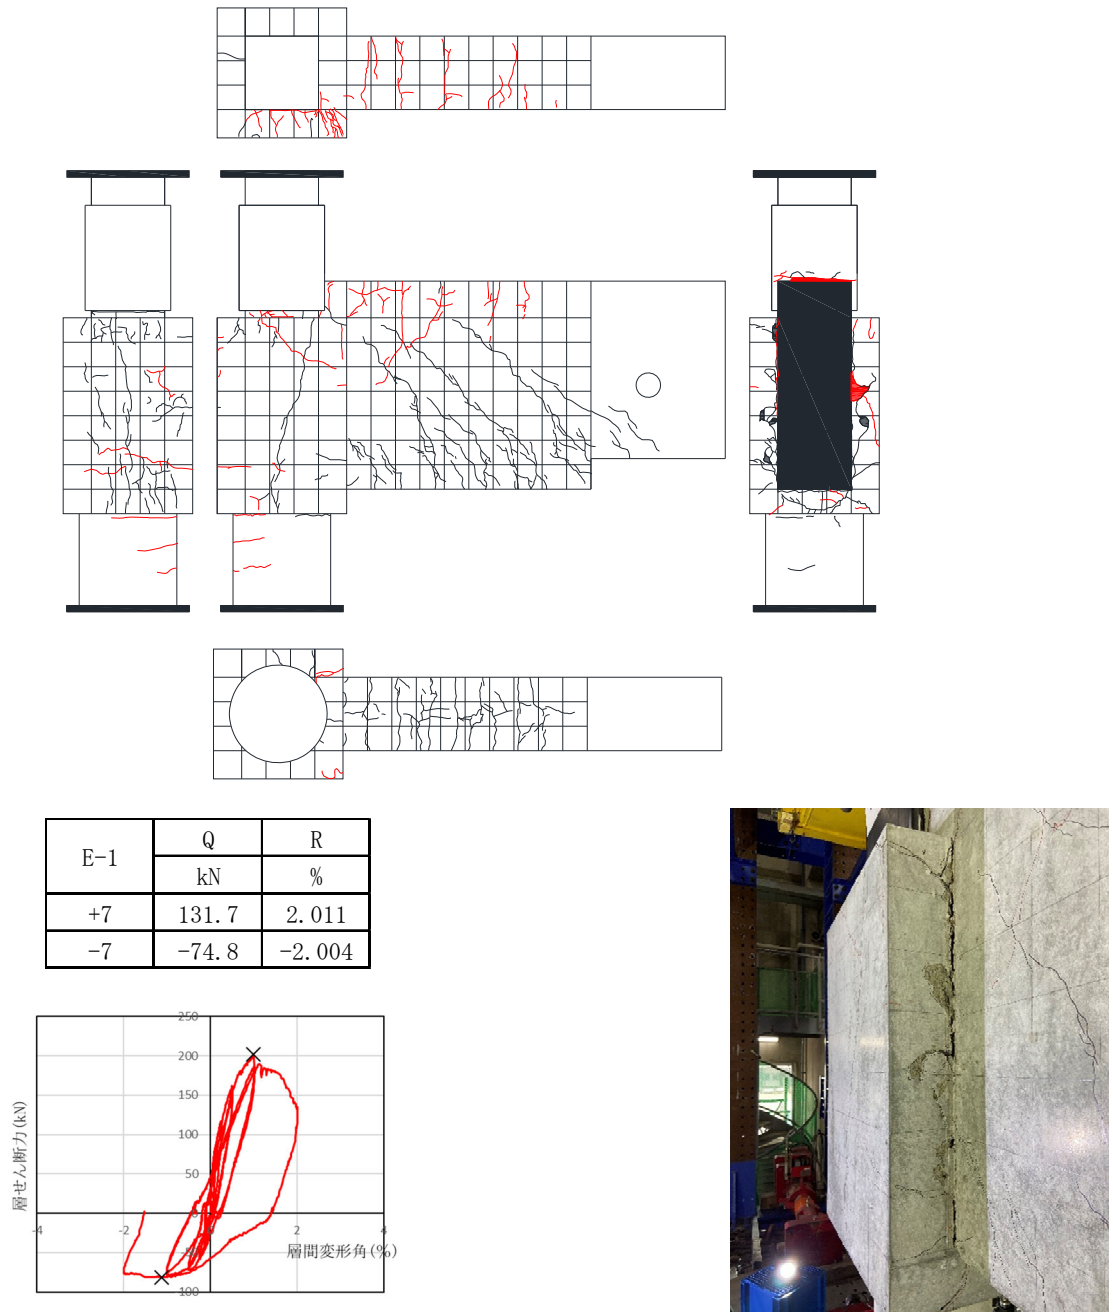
E-1 ひび割れ状況 (4Cycle)
